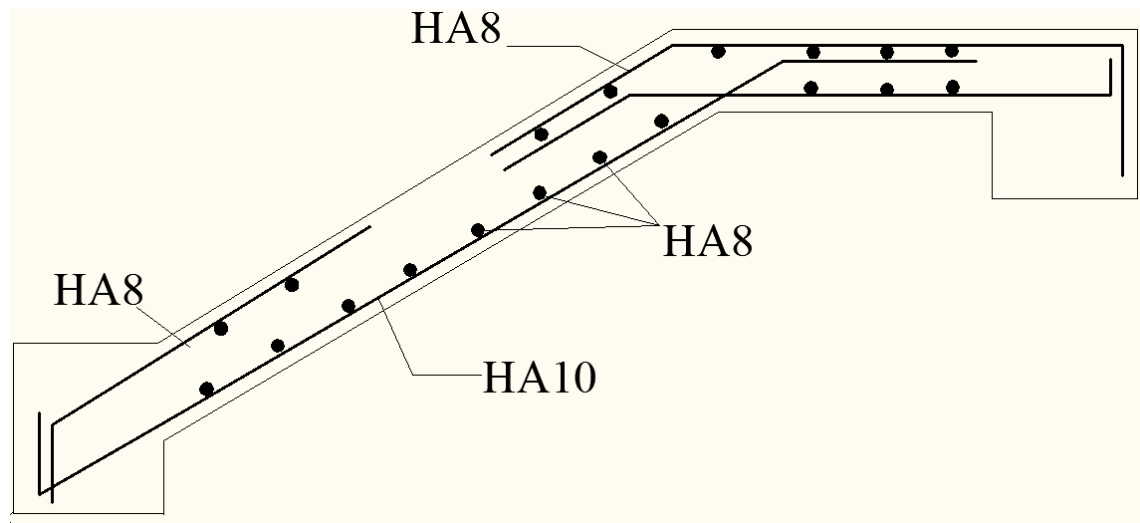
Schéma de ferrailage de l'escalier type 3 (1^{er} et 3^{eme} volée)
